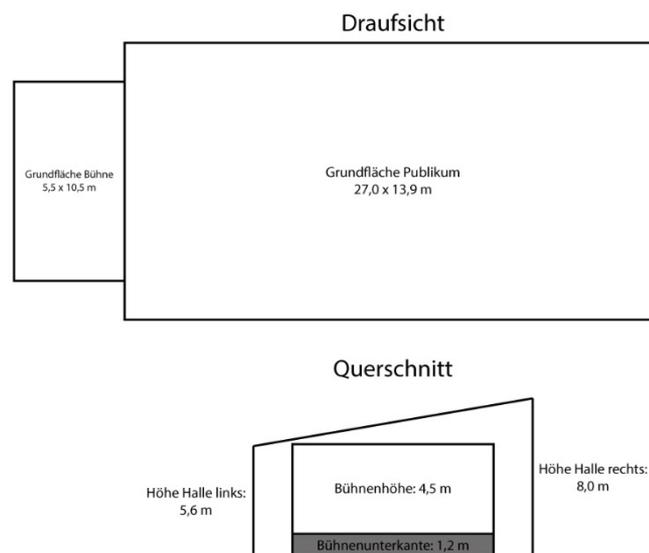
Grundrisse des Veranstaltungsraums
